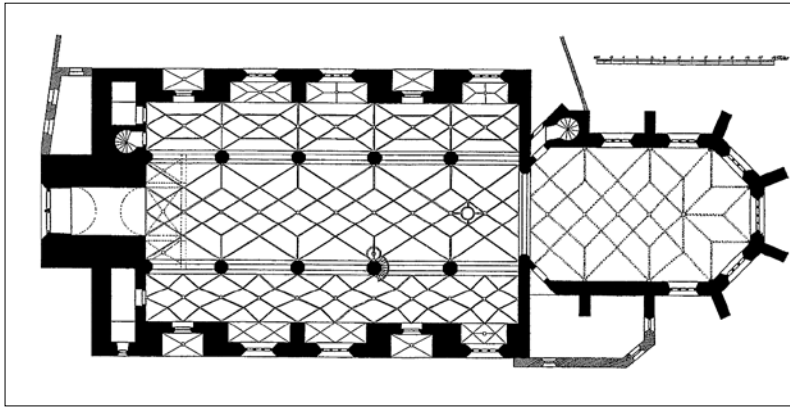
Bruchsal. Grundriss der Stadtkirche St. Marien. Schraffiert: Gotische Sakristei und Anbau am Turm.
